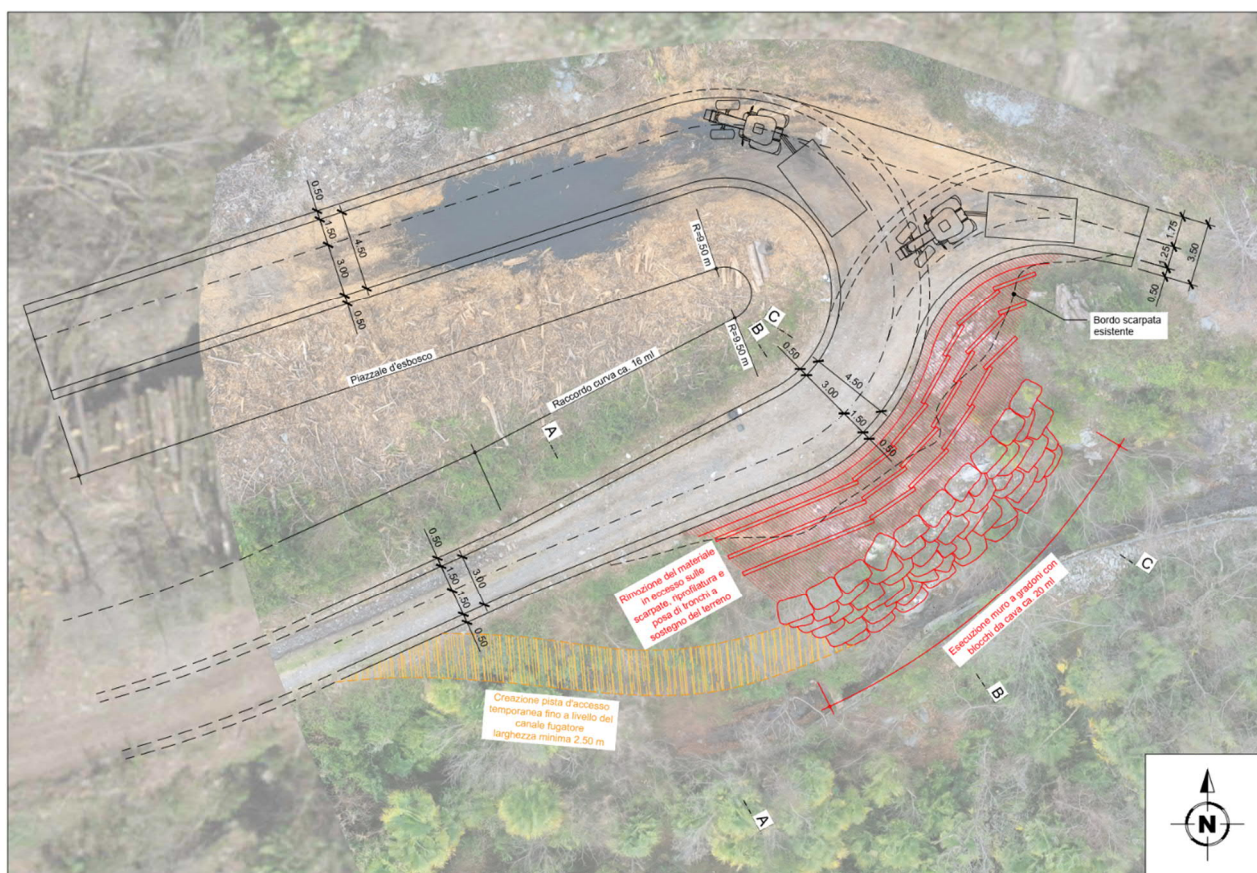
Planimetria estratta dal piano "02 – Piano dell'intervento"
